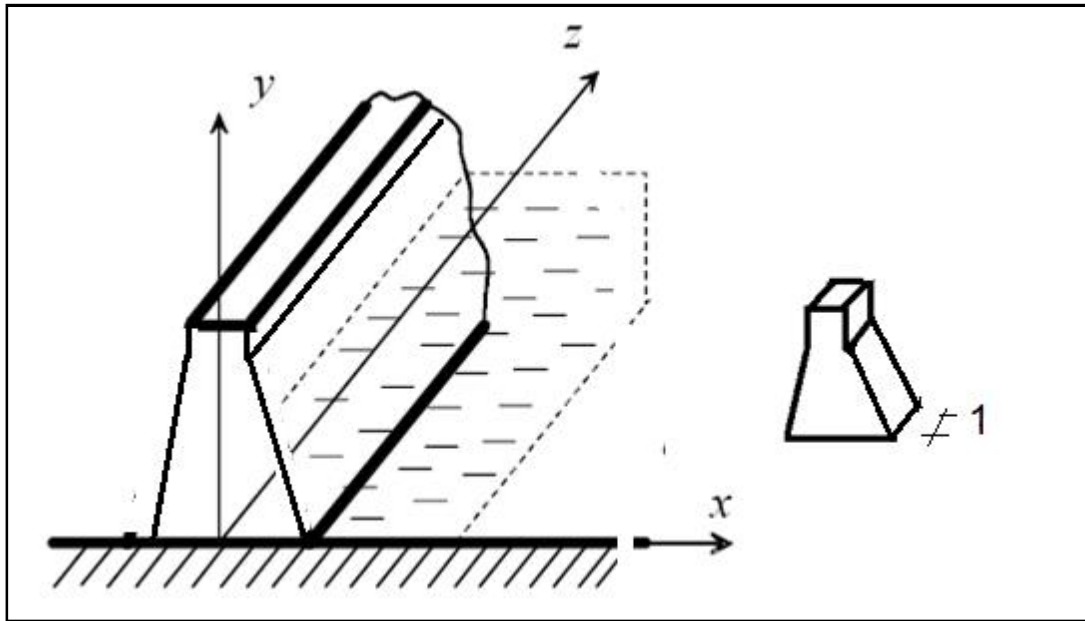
Conditions de déformation plane (exemple d'un barrage en béton).
